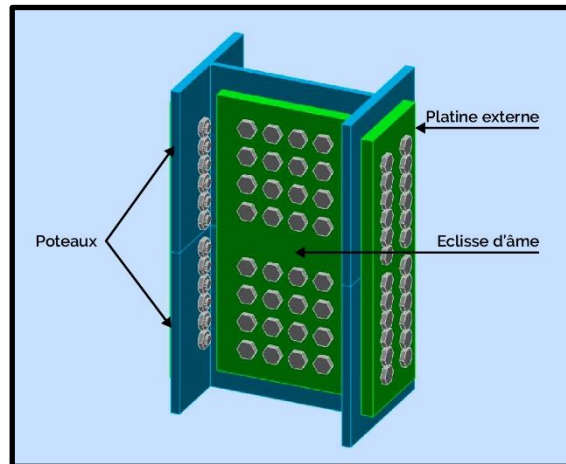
Assemblage poteau HEA 400 – poteau HEA 400 [Autodesk Robot Structural Analysis Professional]
